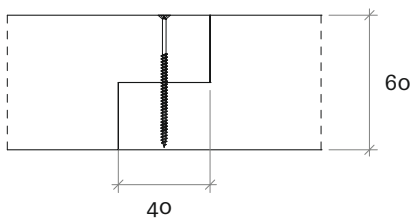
Möglichkeit zur Elementkopplung mit Stufenfalz (Schraube d = 6 mm)
